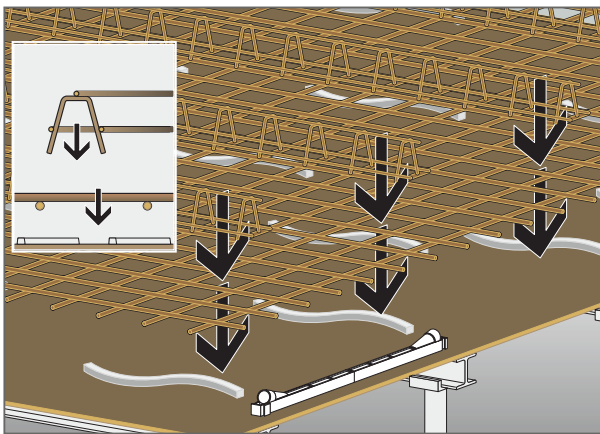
Auslegen der bauseitigen unteren Bewehrung nach Vorgabe Statik.
